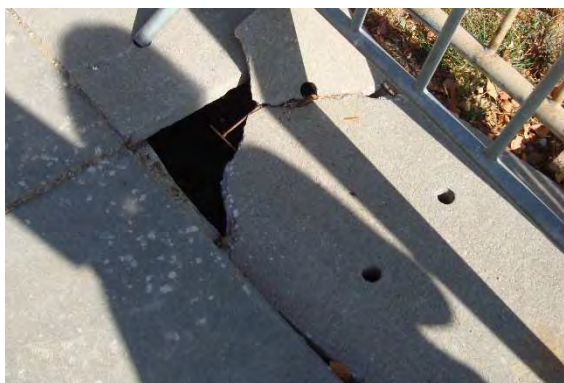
Pavimento exterior: situação em 2018-09-18
